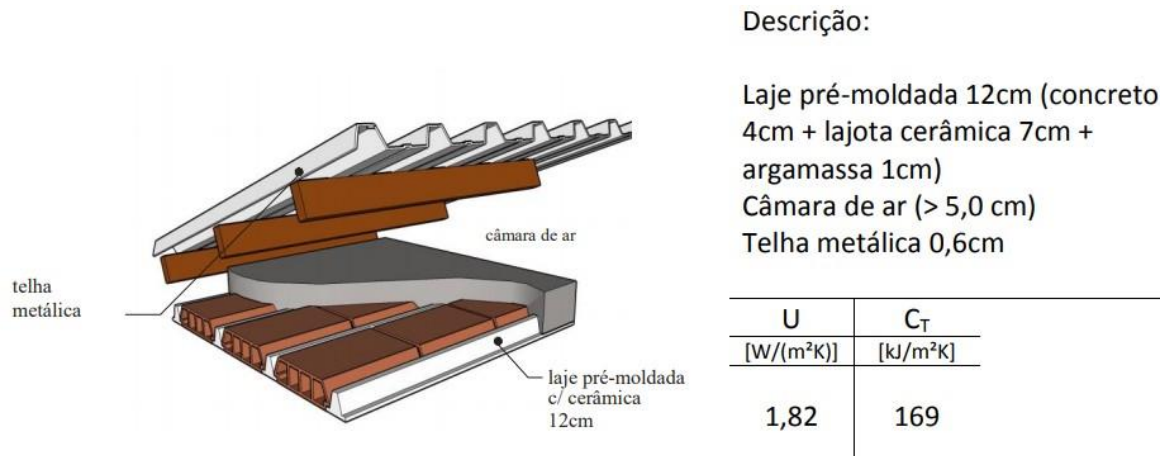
Cobertura metálica sobre laje pré-moldada (INMETRO, 2013).
